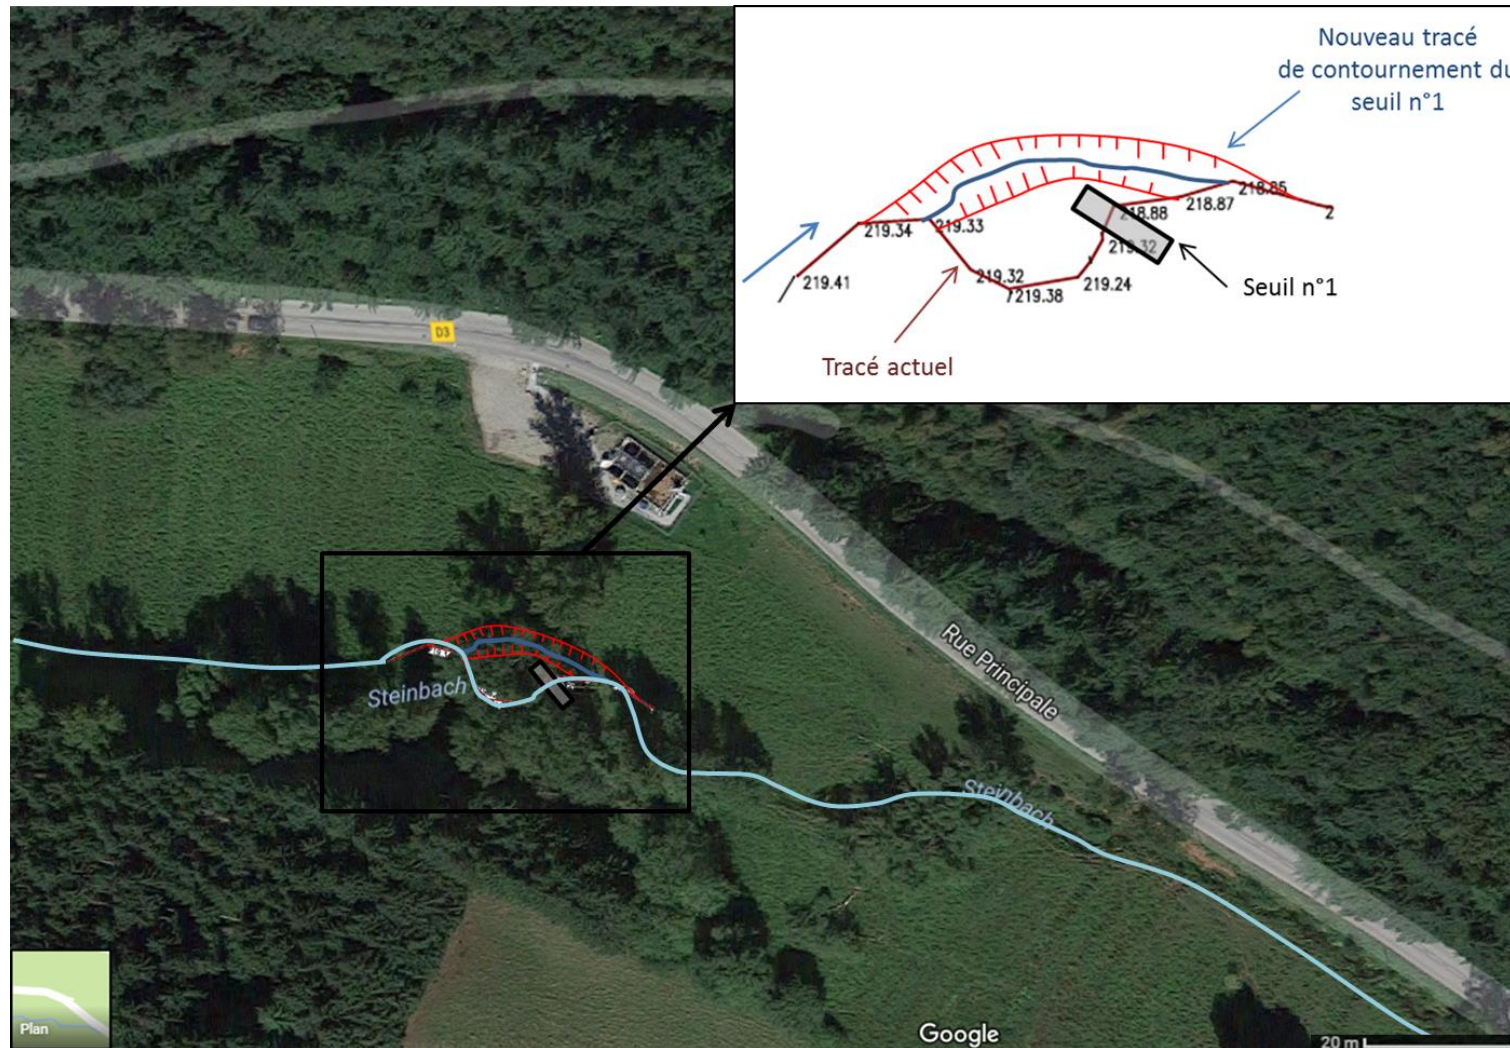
Vue en plan du contournement de l'ouvrage n°1
